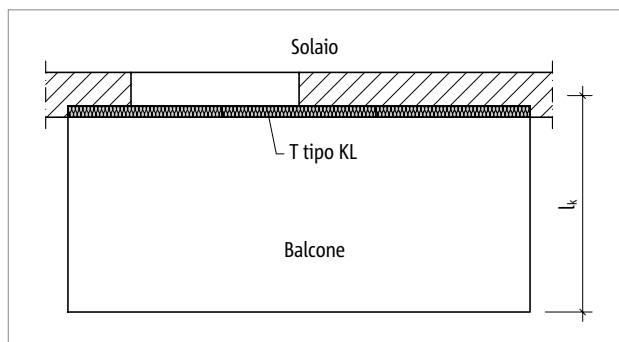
Schöck Isokorb® T tipo KL: balcone a sbalzo
